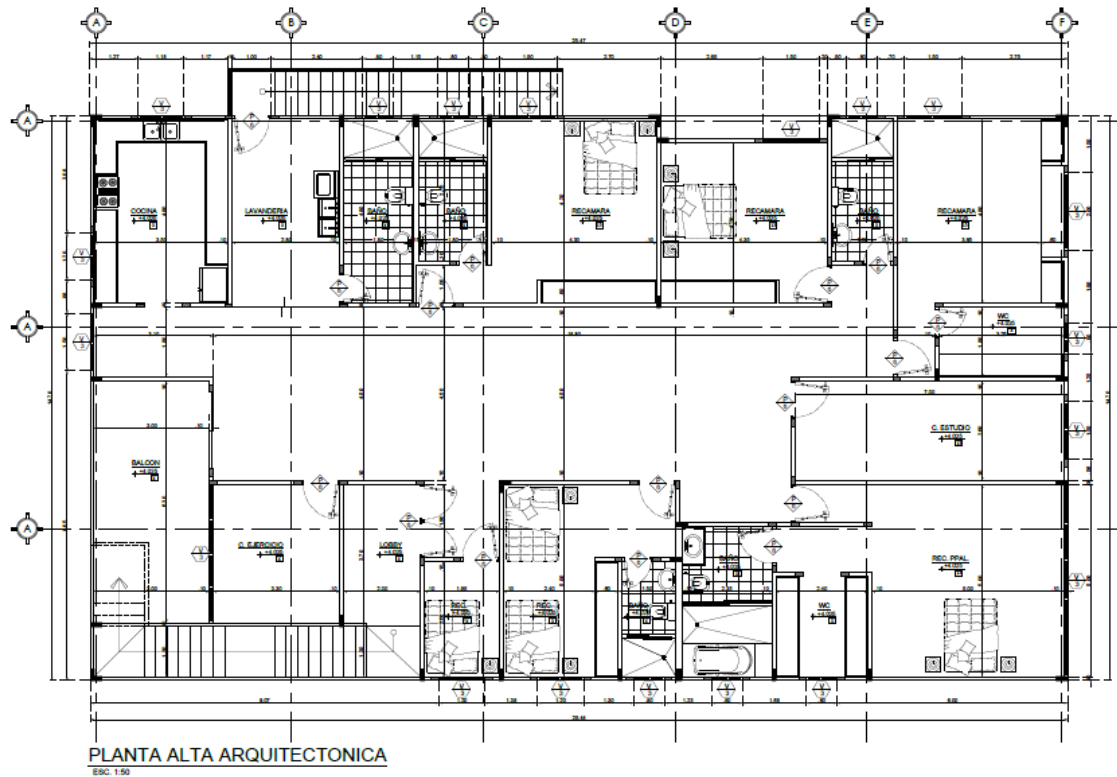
Planta arquitectónica de la residencia unifamiliar. Fuente: Planos del proyecto, 2023.
